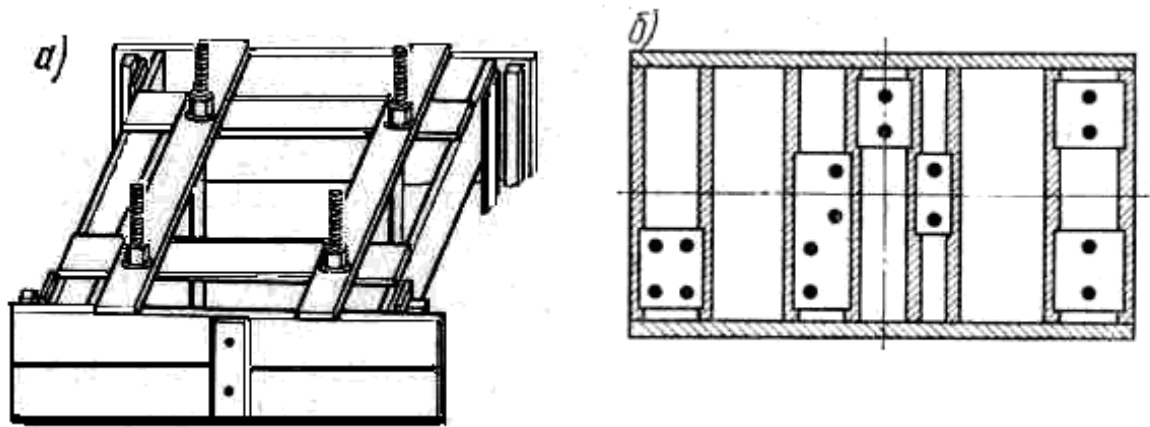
Монтажний кондуктор: а - загальний вигляд; б - план;
